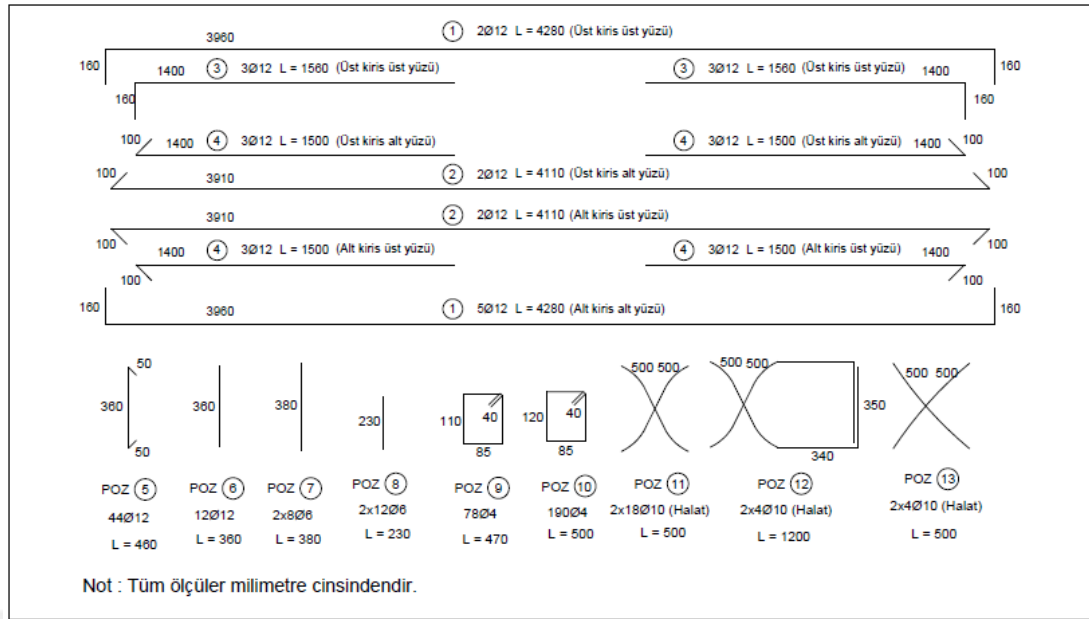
RRxb Kirişi kiriş donatı planı ve kesitleri
